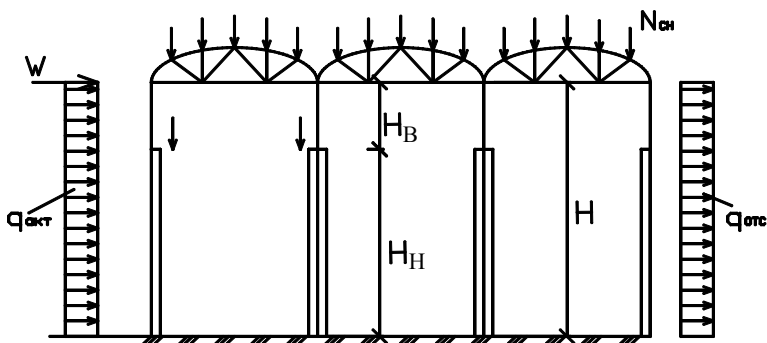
Поперечный разрез здания с упругой конструктивной схемой
